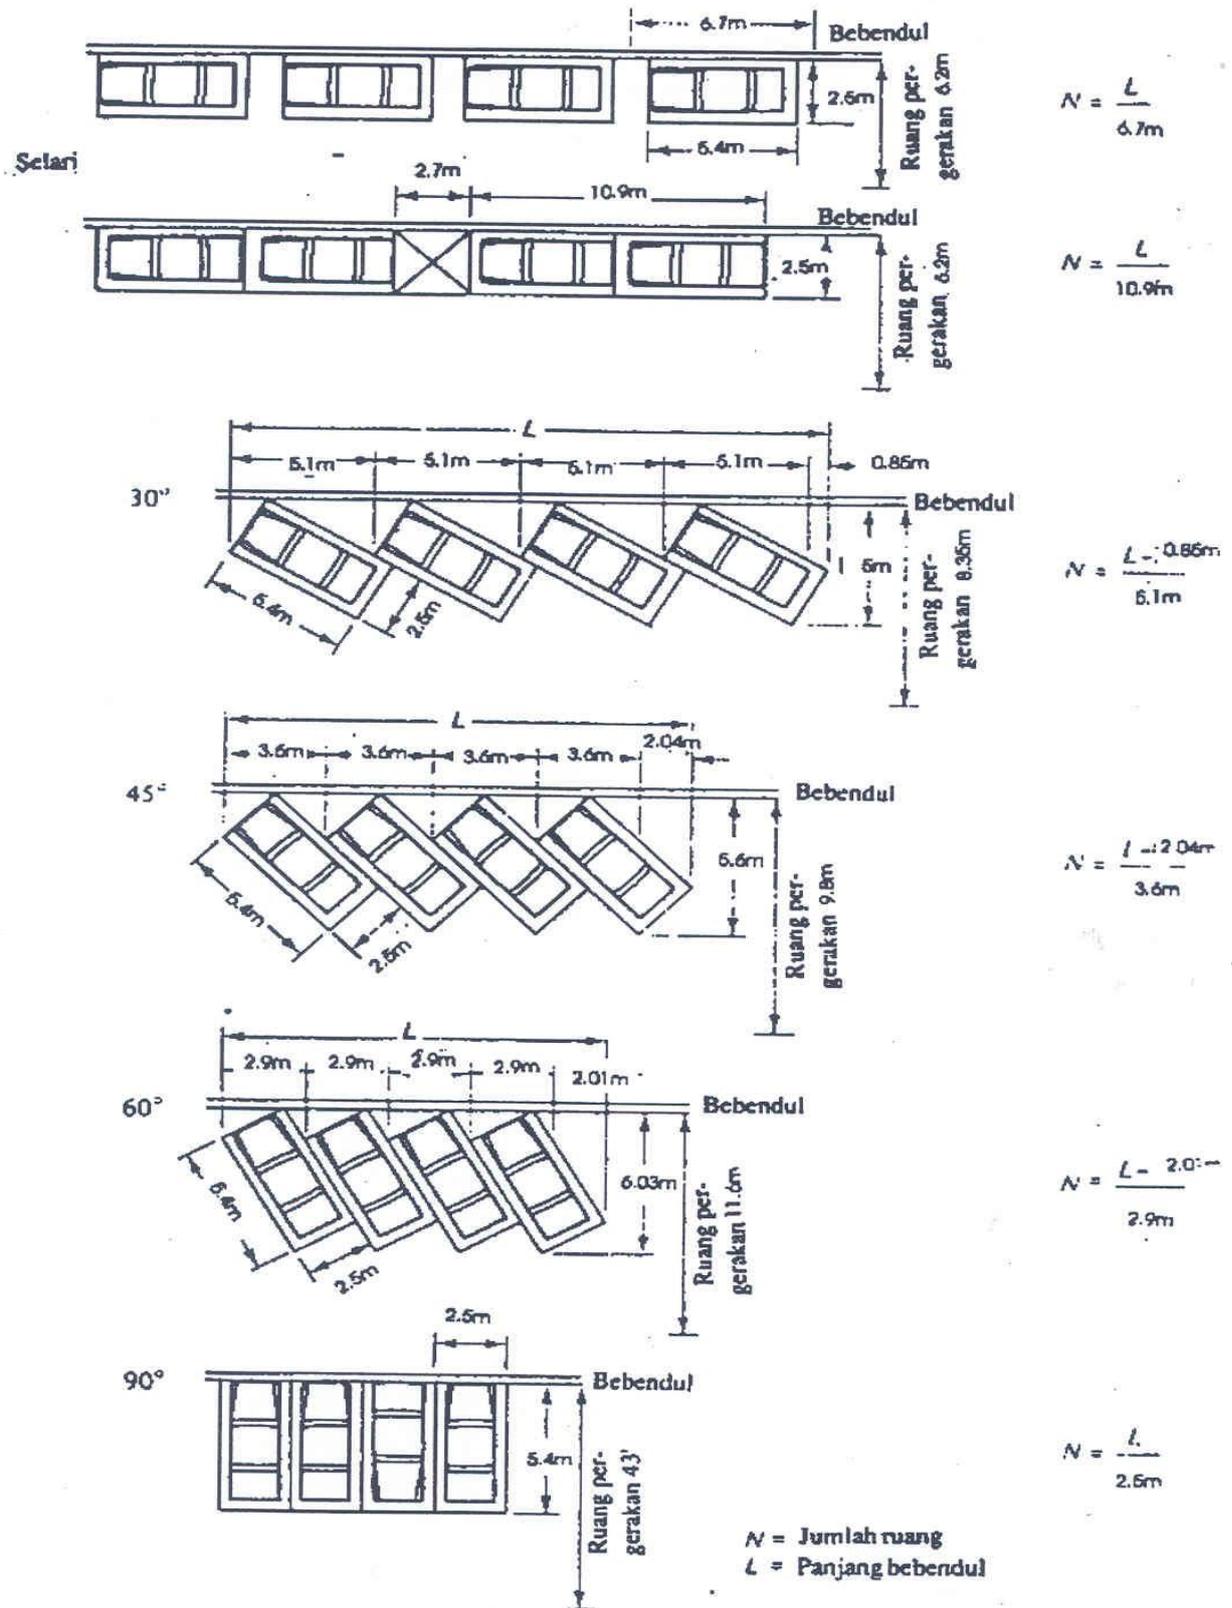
Cadangan Reka Bentuk Tempat Letak Kereta Di Lapangan
